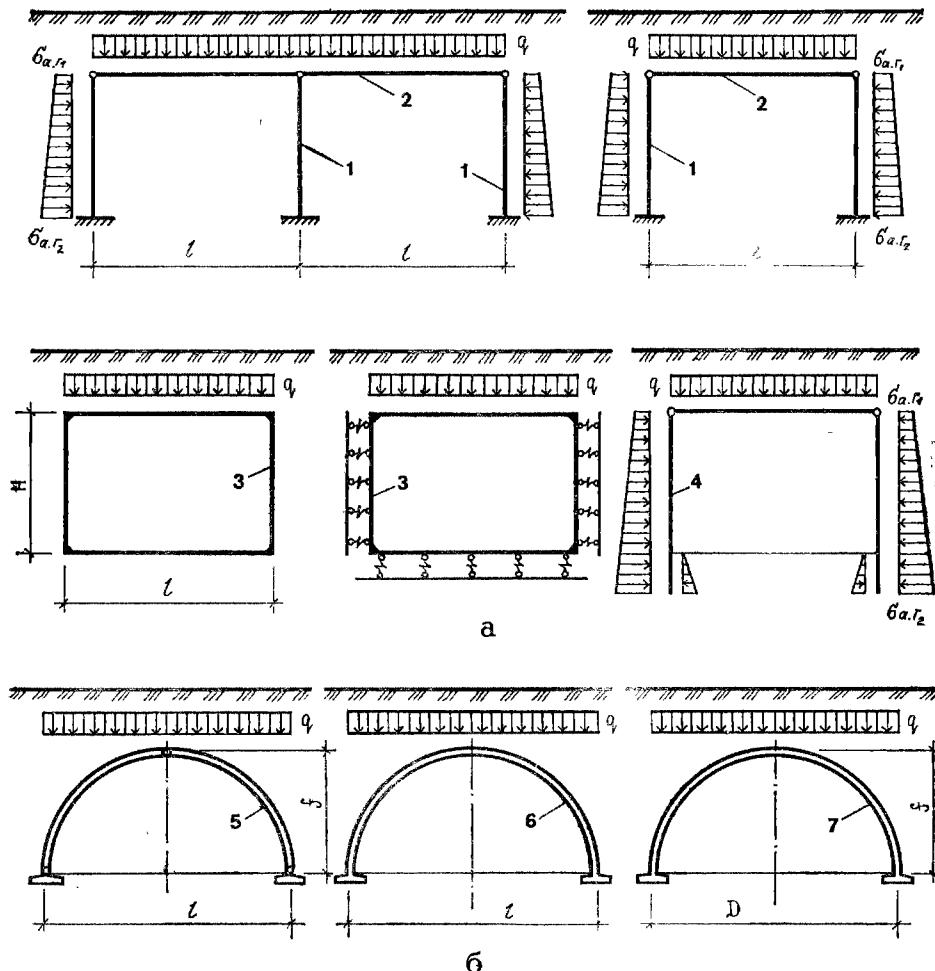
Расчетные схемы одноэтажных зданий:
